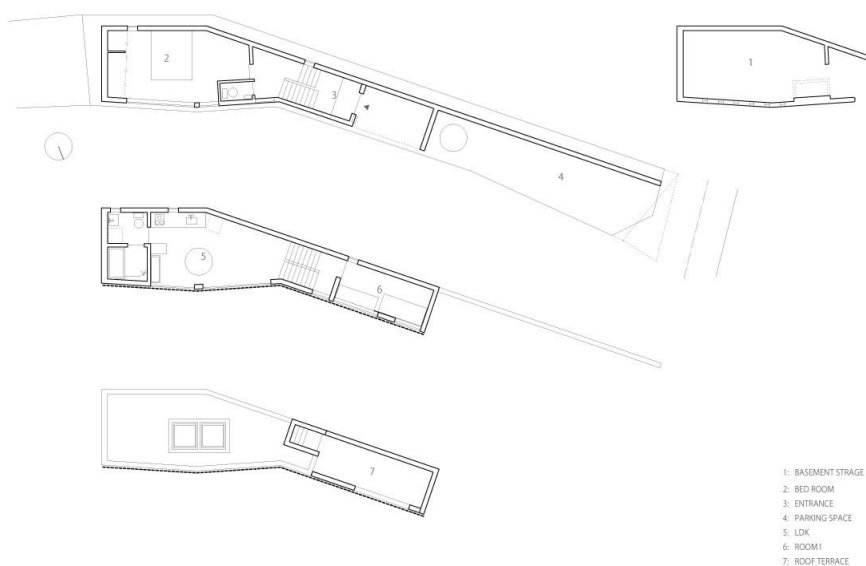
Desenhos técnicos: Plantas da habitação (Archdaily, 2011)
